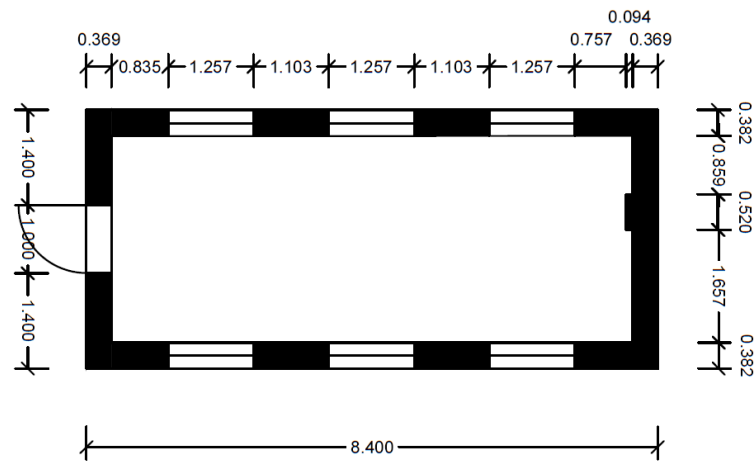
Grundriss Erdgeschoss Stellwerkgebäude nach Aufmaß vom 087.05.2025
